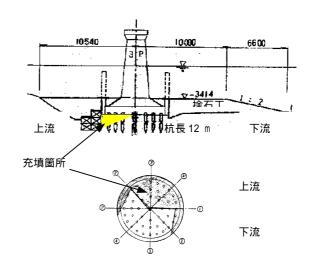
3 P充填箇所の断面図(上)と平面図(下)
